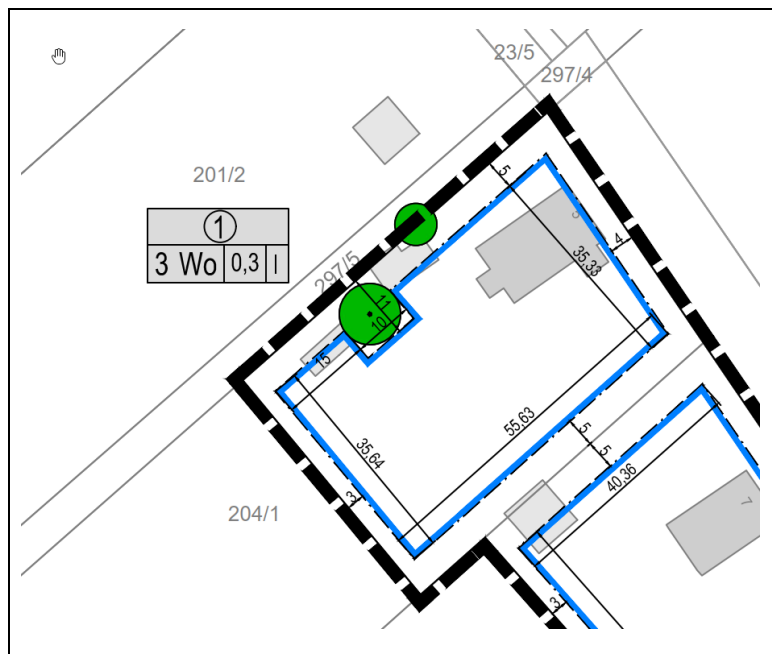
Hausnummer 5 - Lageplan (o.M.)
